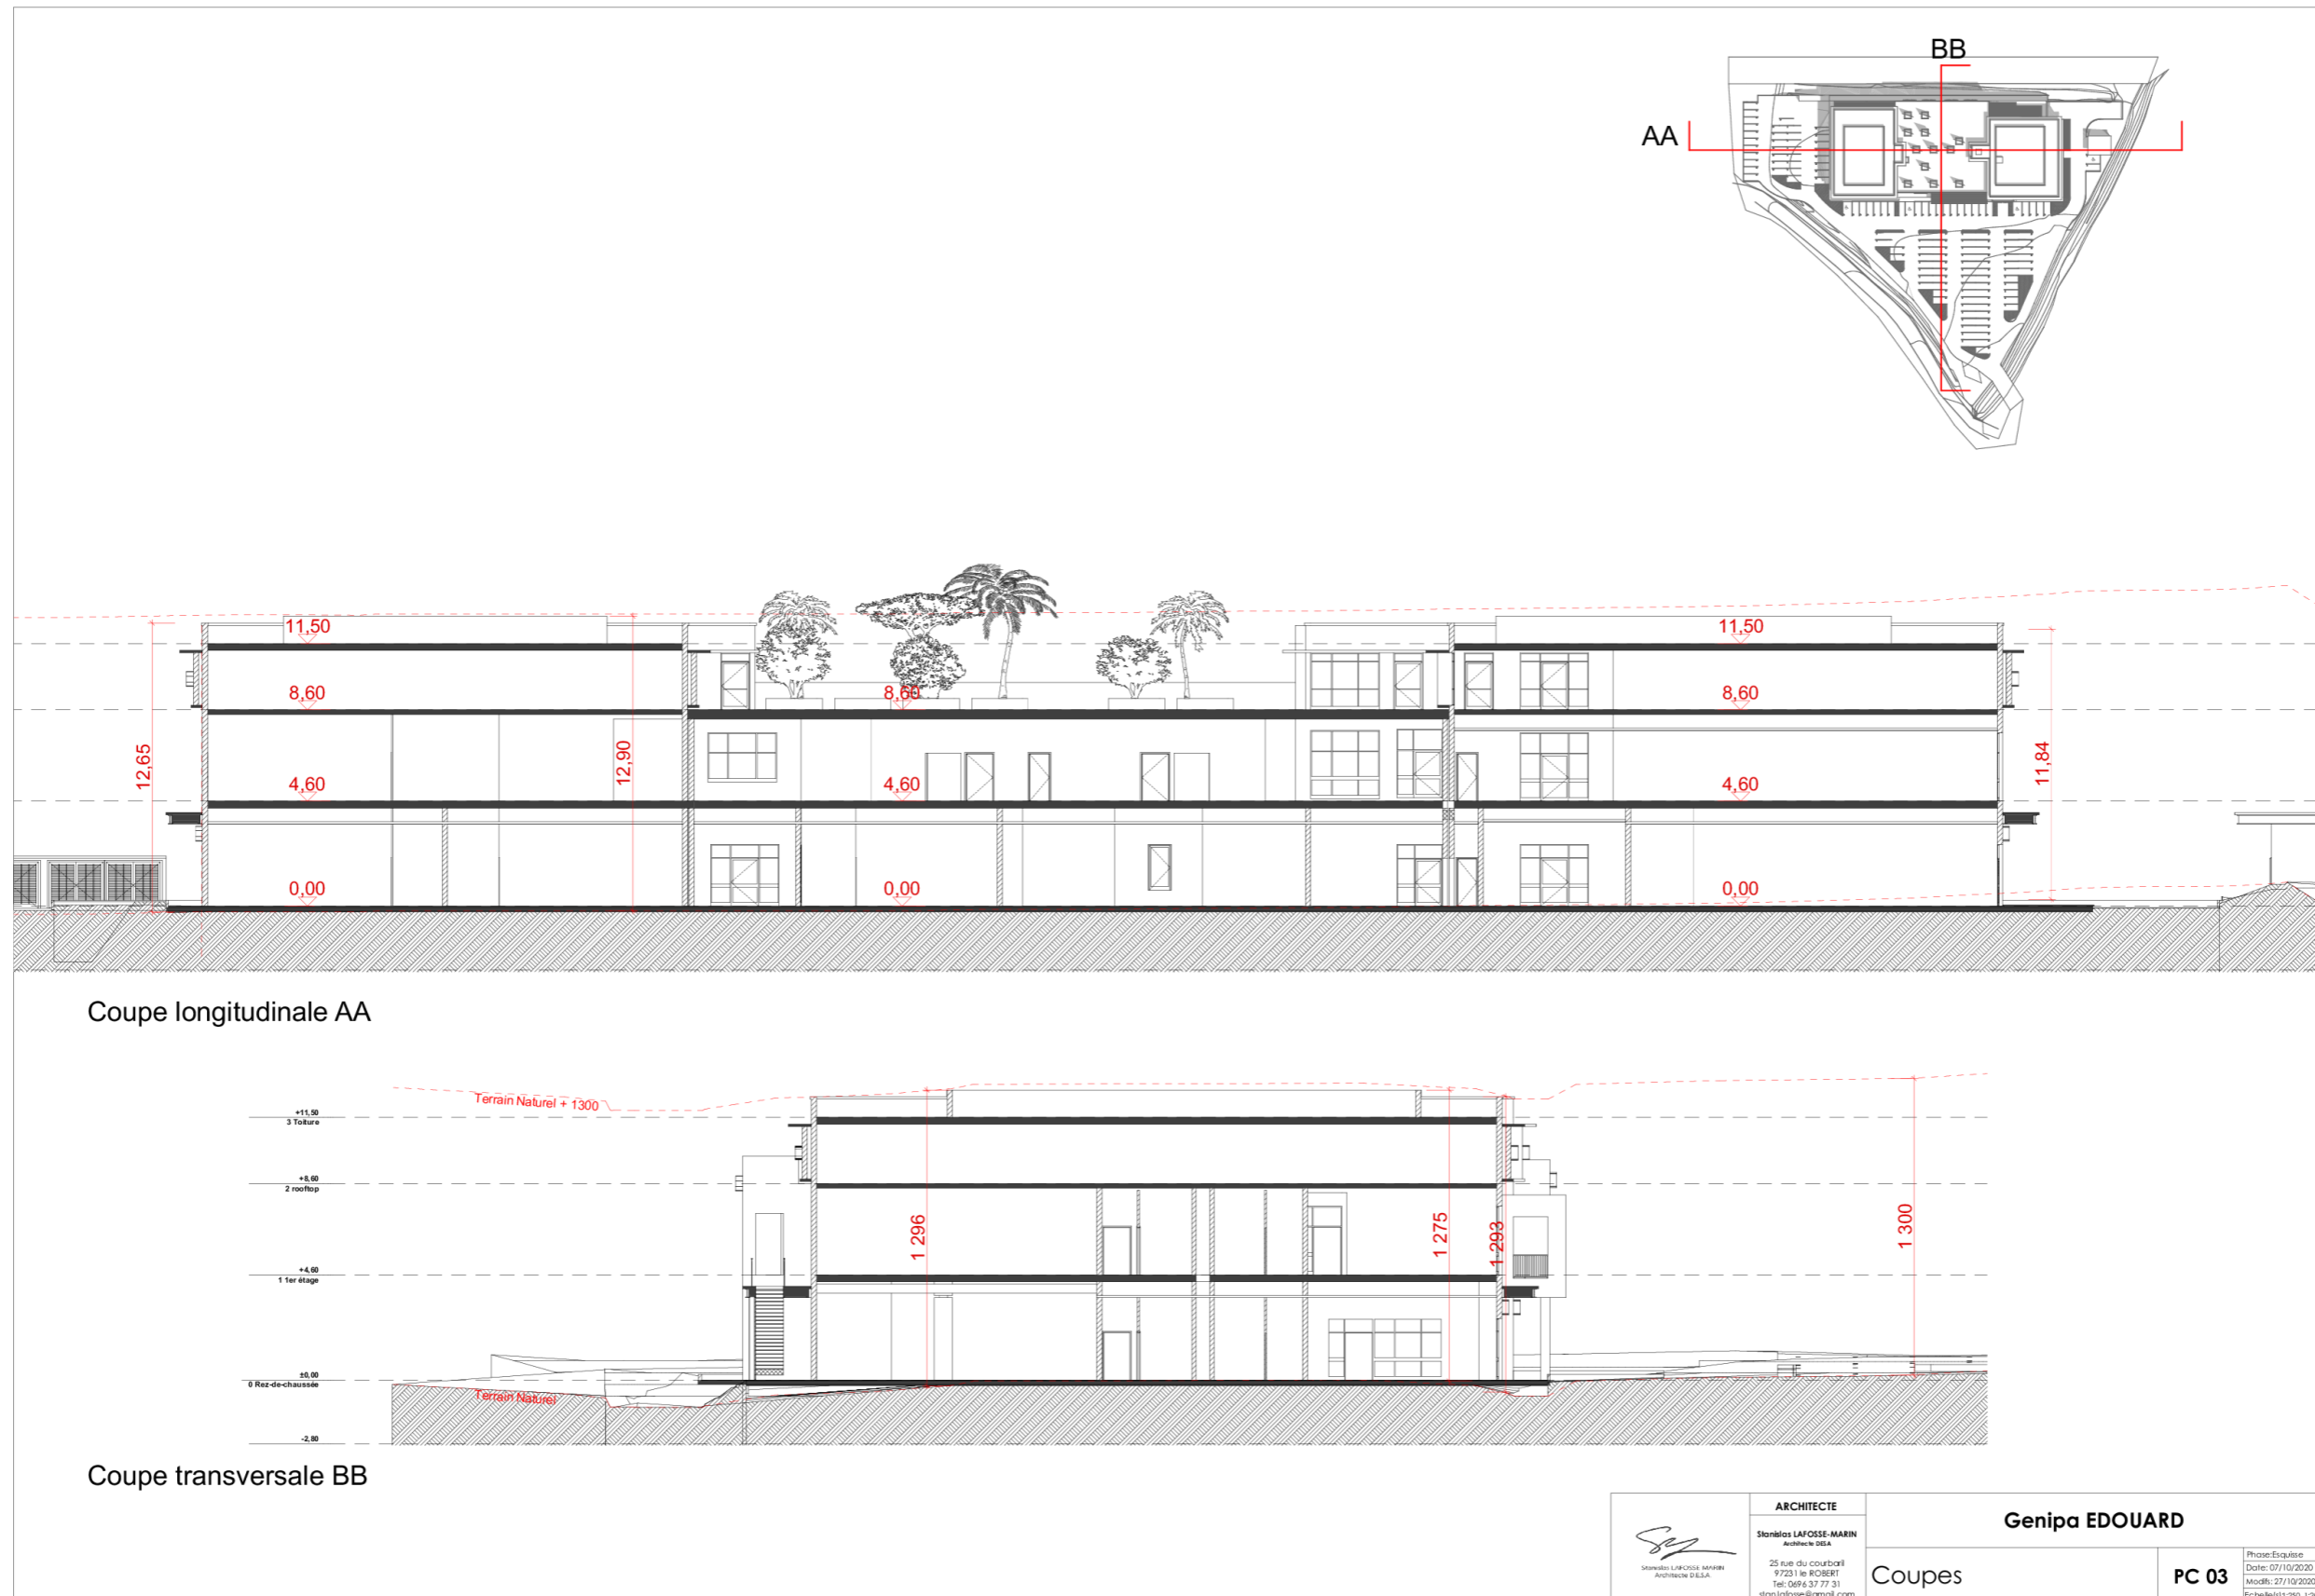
Plans en coupes du bâtiment projeté (source : Architecte Stanislas LAFOSSE-MARIN, version du 27/10/2020)
